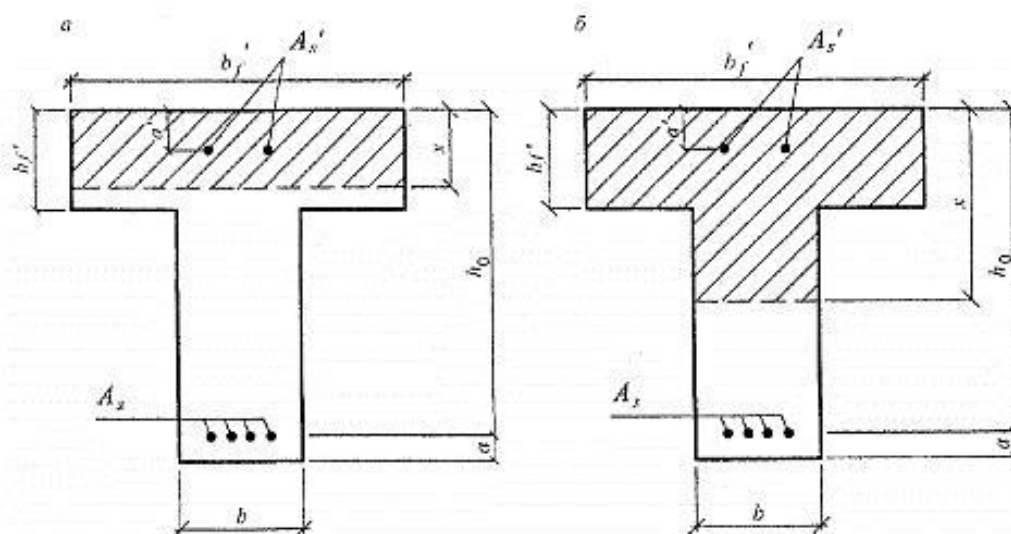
Положение границы сжатой зоны в сечении изгибаемого железобетонного элемента.
